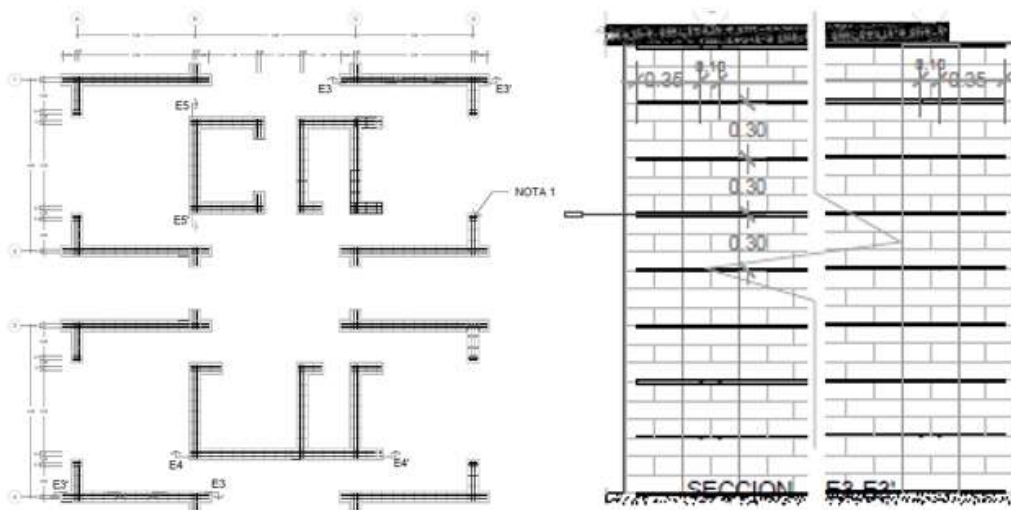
Muros y Estructura de refuerzo interno horizontal dos tres dormitorios
